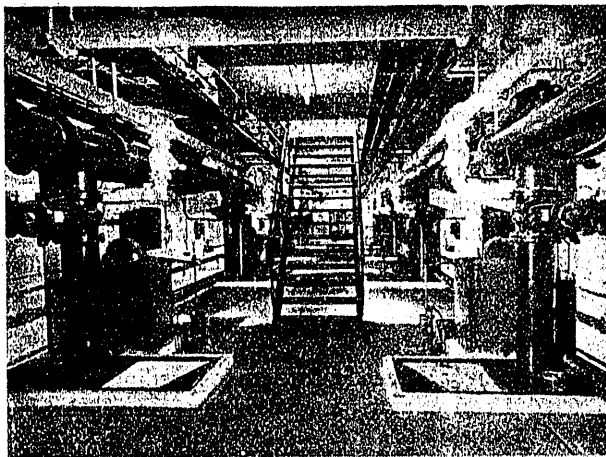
Falkirk. Galería inferior de los filtros.
